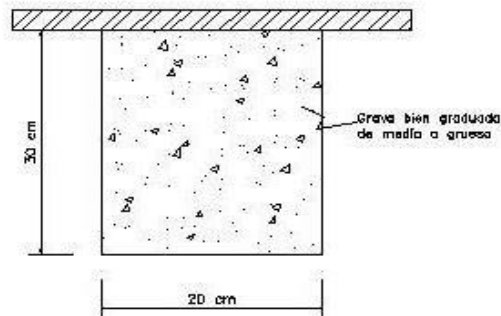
DETALLE DE DRENES SUPERFICIALES AL NIVEL DE MÁXIMA EXCAVACION
